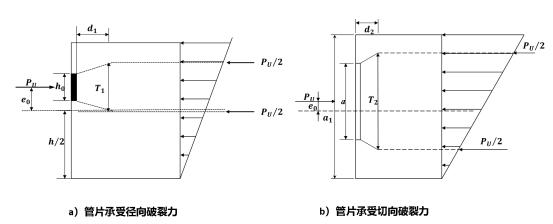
钢纤维混凝土管片承受推进力作用示意图
